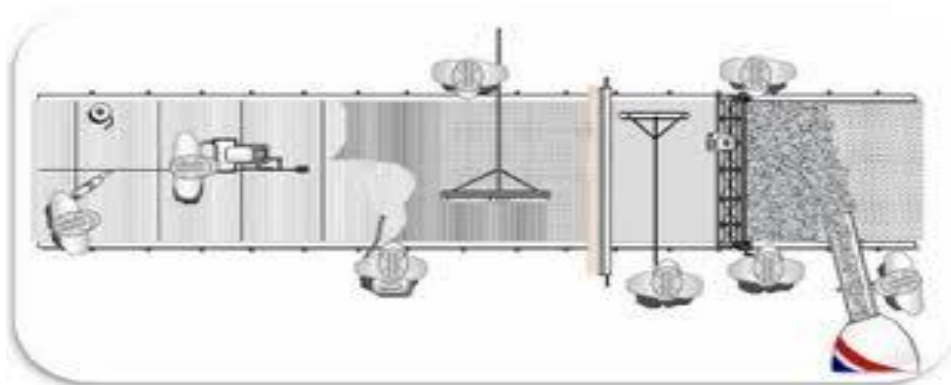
Proceso de ejecución de un pavimento rígido
